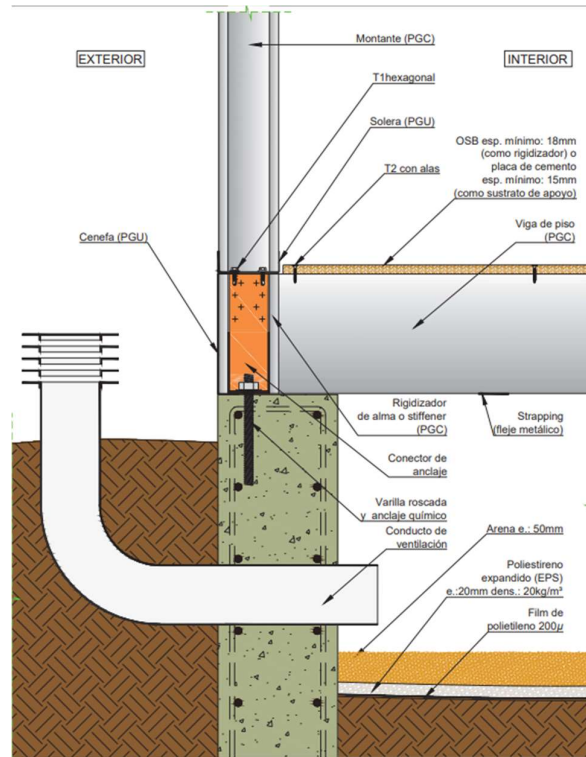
| Detalle fundación. Fuente: www.incose.org.ar
